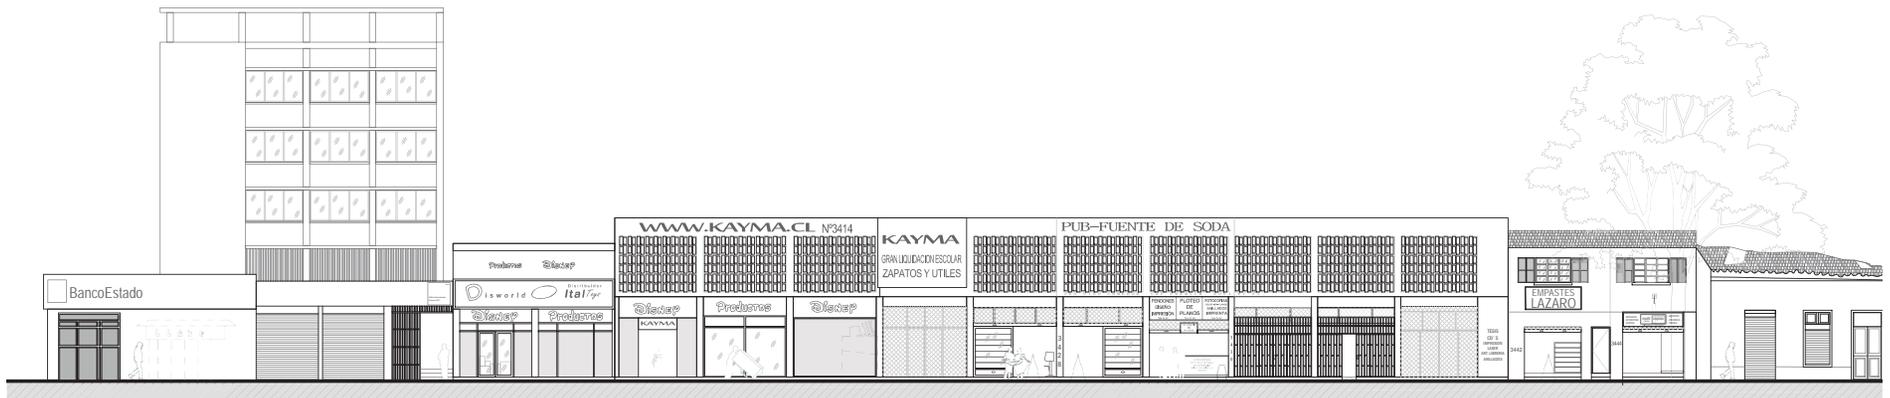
Elevación de fachada Norte (Av. Ecuador) del terreno. Fuente: Elaboración propia.
